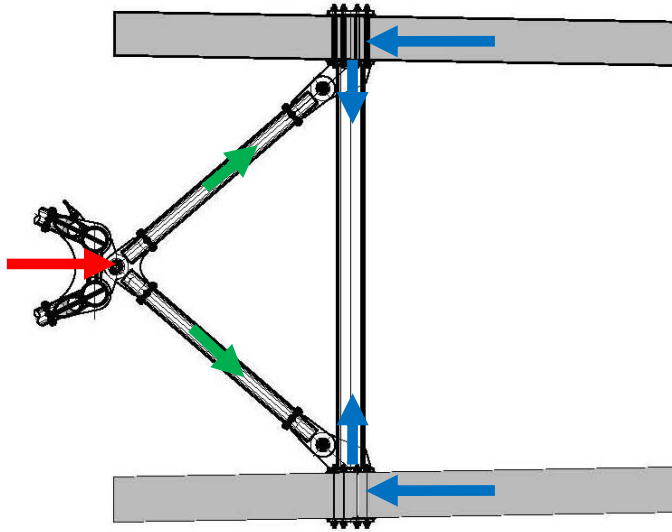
Detalle conexión cubierta metálica con vigas portagrada.
